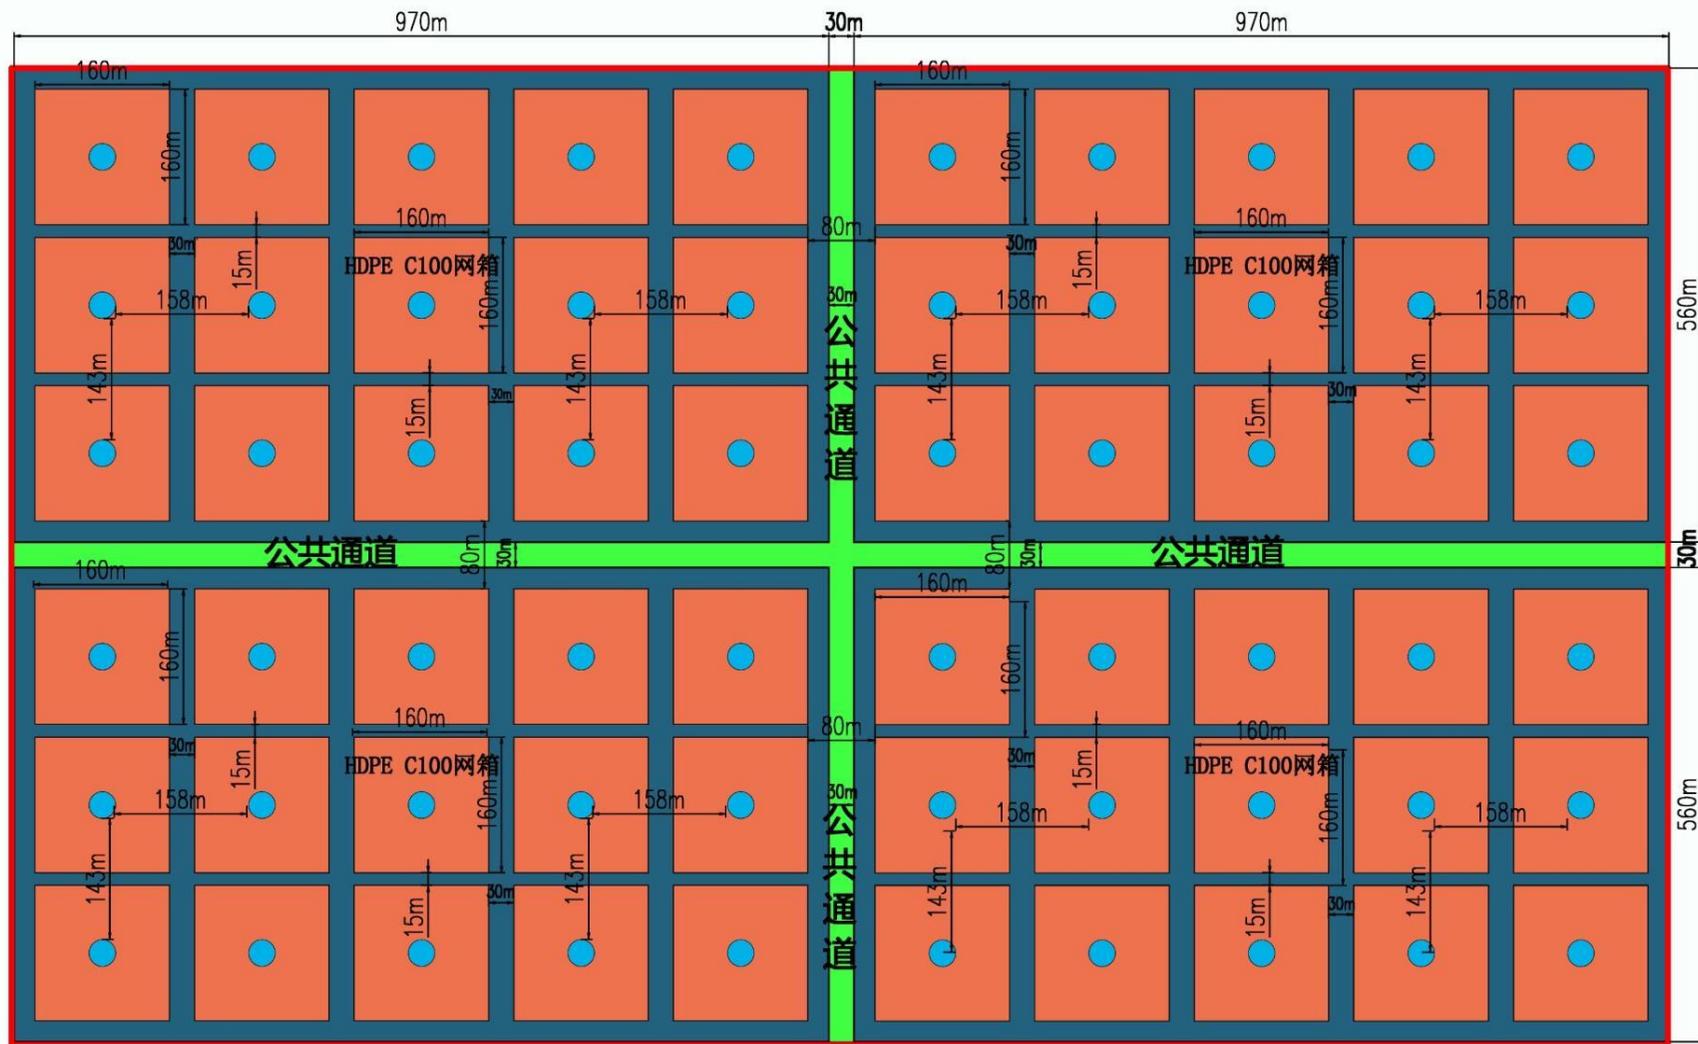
B 区 C100 型深水网箱用海区块内平面布置
